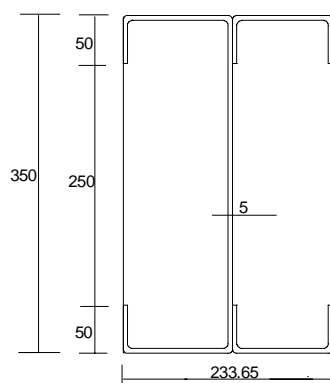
Seção Transversal da Viga VD1 Especificada (dimensões em mm)
